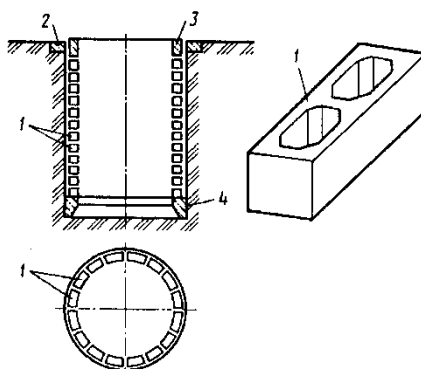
Сборный опускной колодец из пустотелых прямоугольных блоков:
